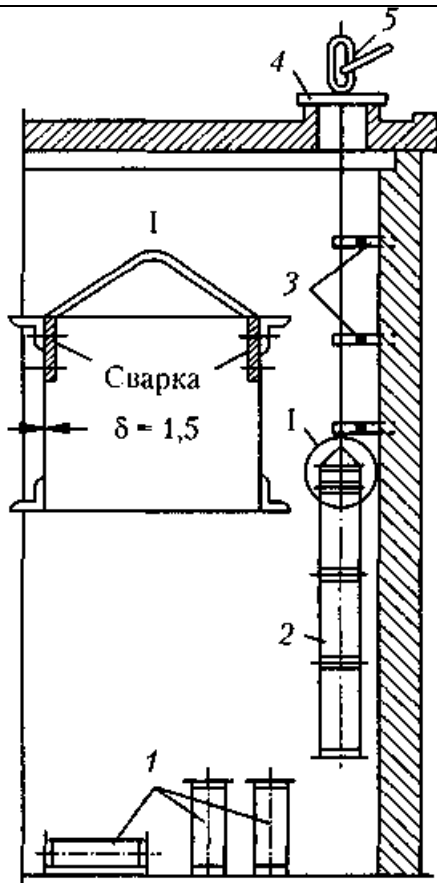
Монтаж вертикальных воздуховодов методом наращивания снизу:
